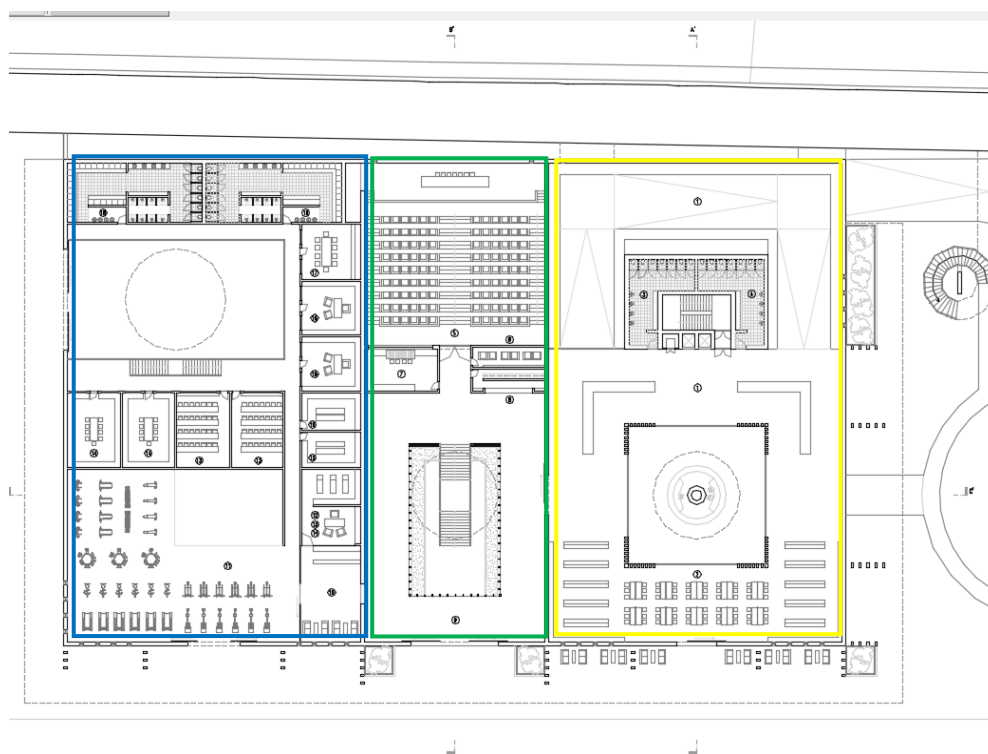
Planta do primeiro piso do Polo de Desenvolvimento Náutico.
